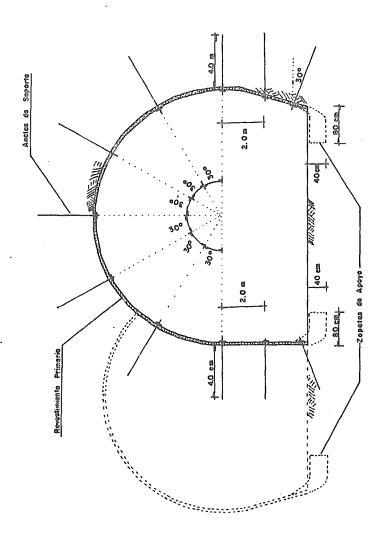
ZAPATAS Y ANCLAS DE AFOVO TUNEL DE AMDEM
